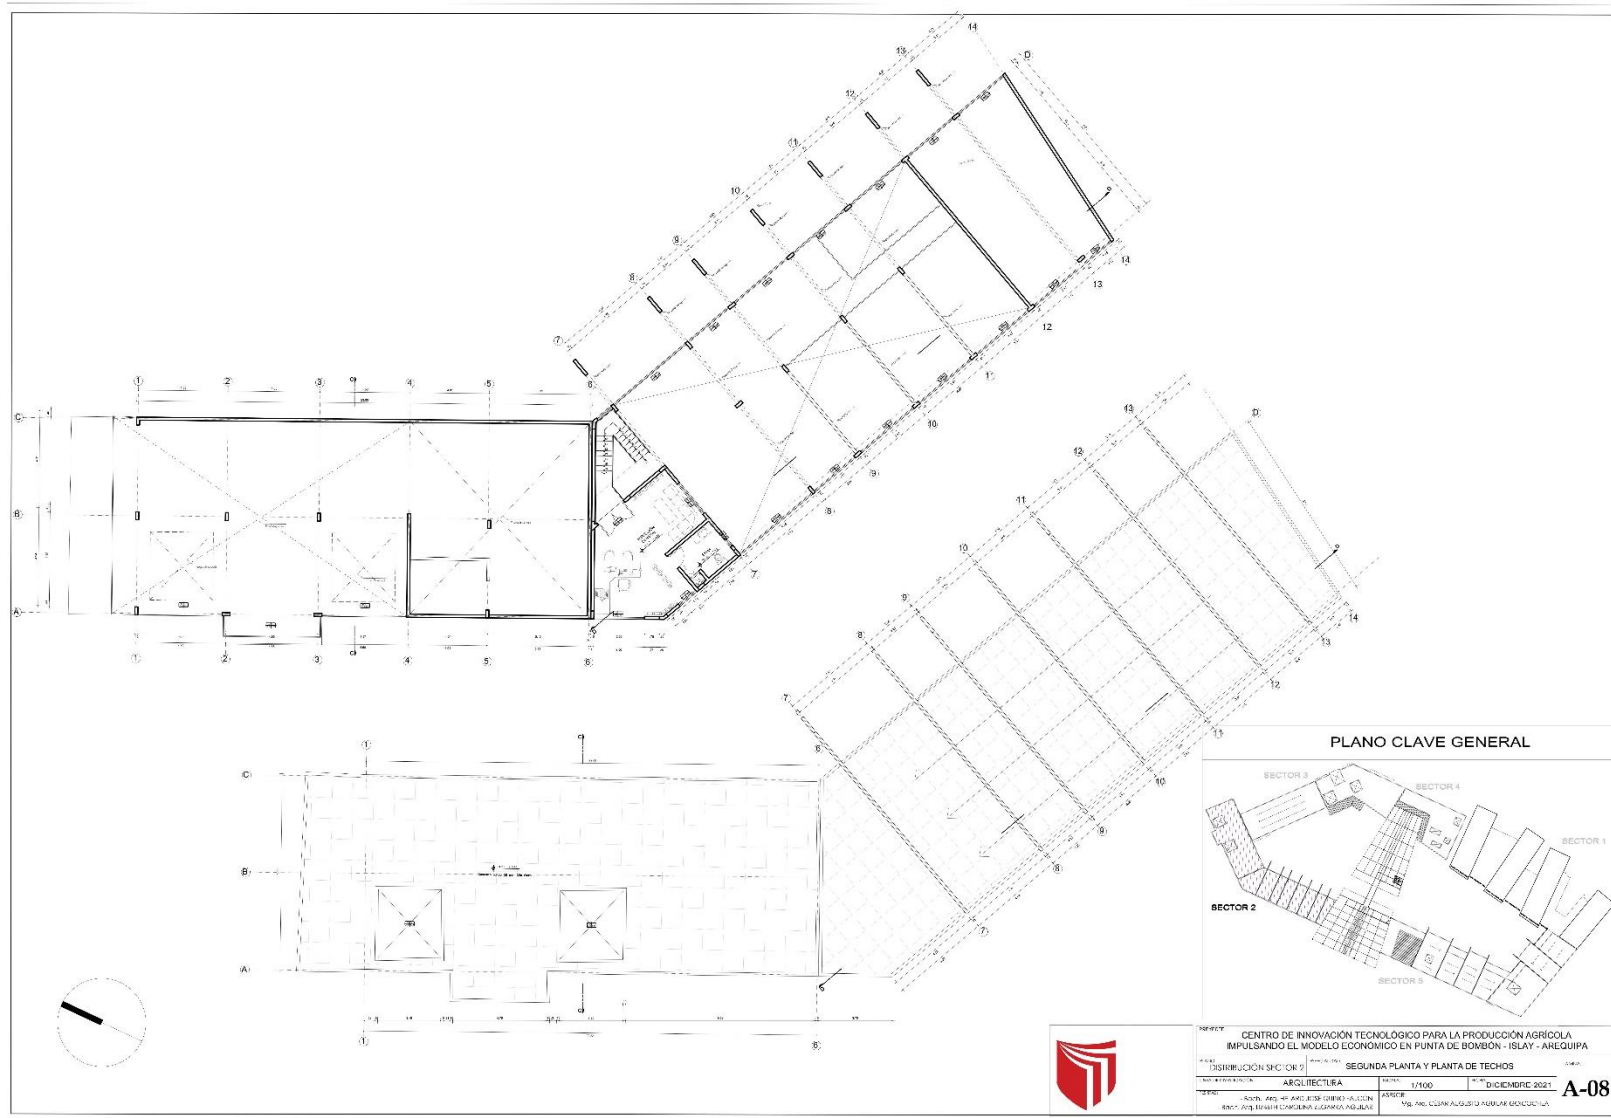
A – 08 Sector 2 - Plano de Distribución de Segundo Nivel y Planta de Techos.
